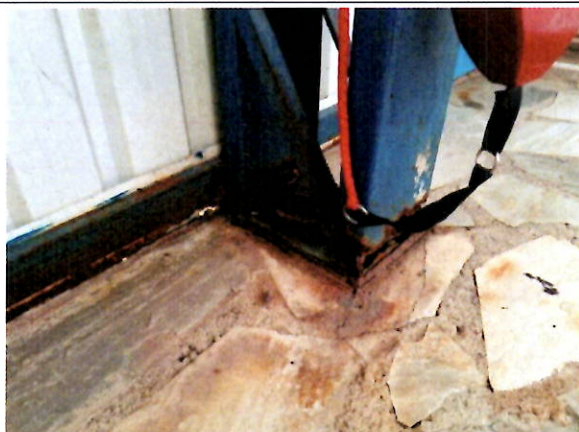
Oxidação da base dos pilares da estrutura metálica que apoia a cobertura
